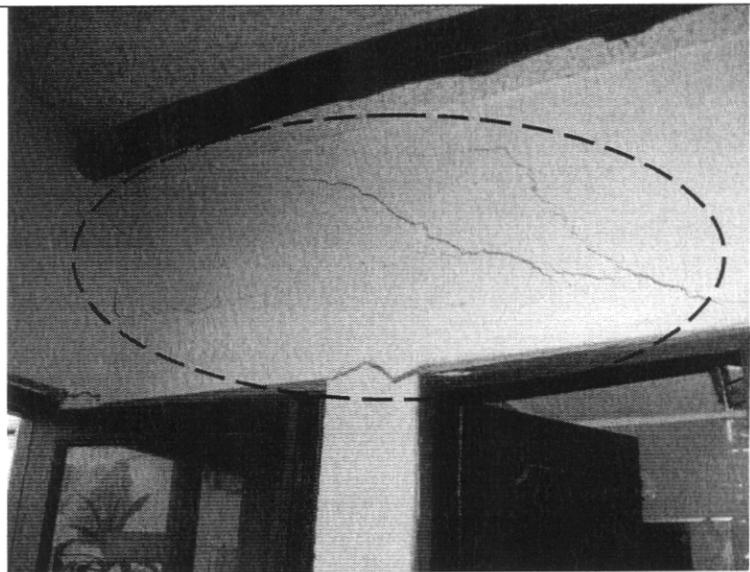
Detalle de los agrietamientos en los muros de mampostería al interior del predio de la Calle 97A No. 10-42
